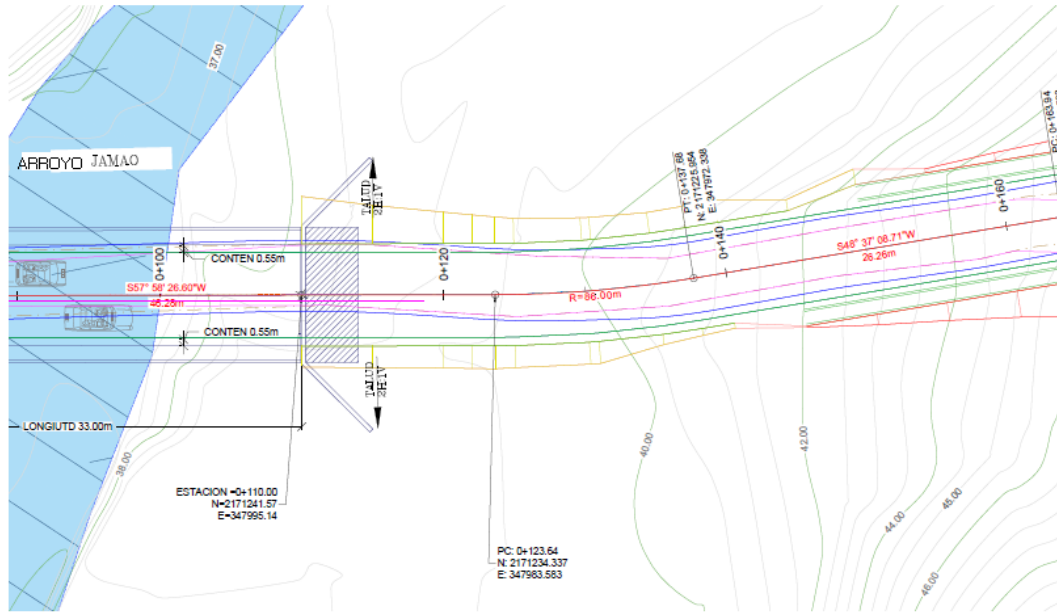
Planta y elevación del tramo de acceso al puente sobre el Arroyo Jamao
